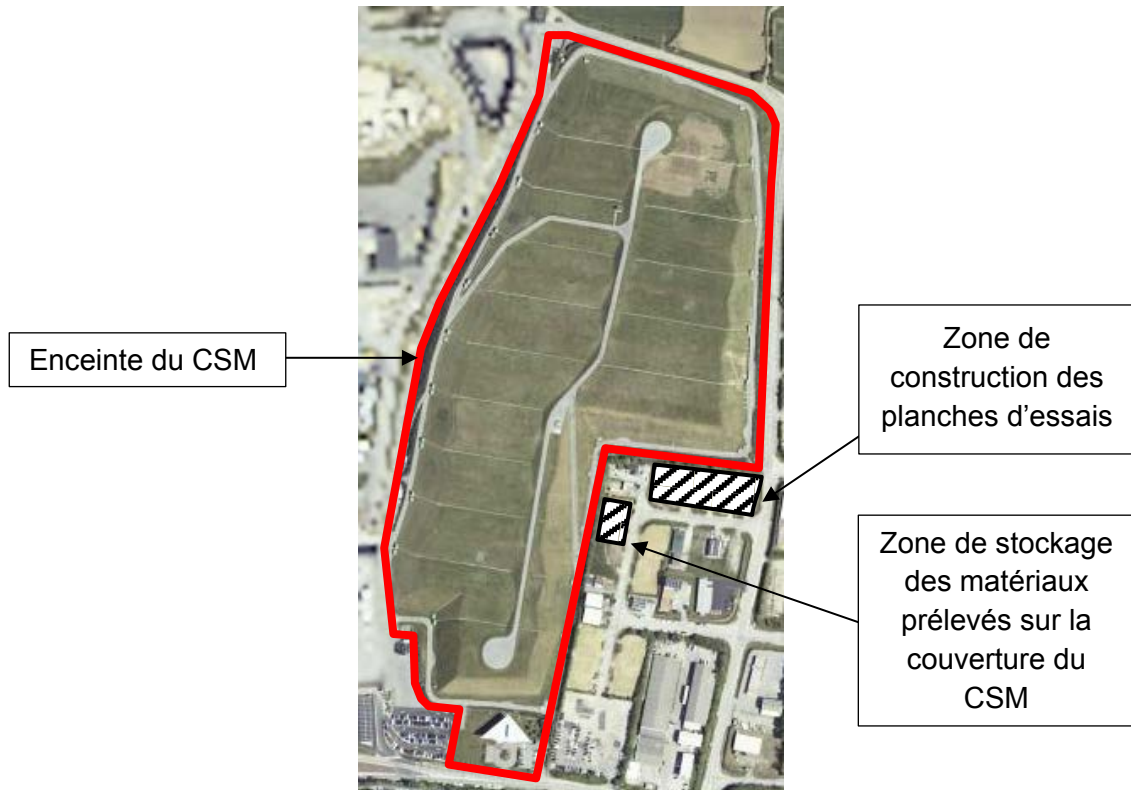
Plan de situation de la zone de construction des planches d'essai
